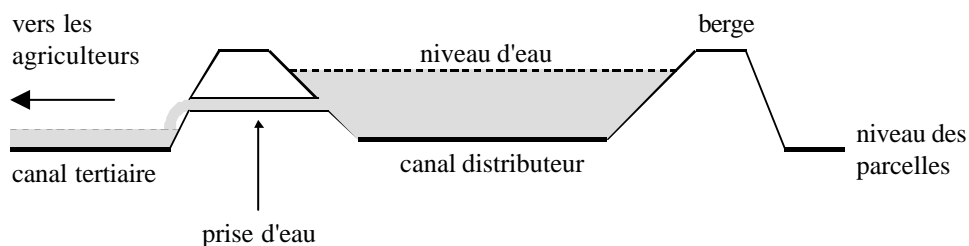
Coupe transversale d'un canal distributeur au niveau d'une prise d'eau
